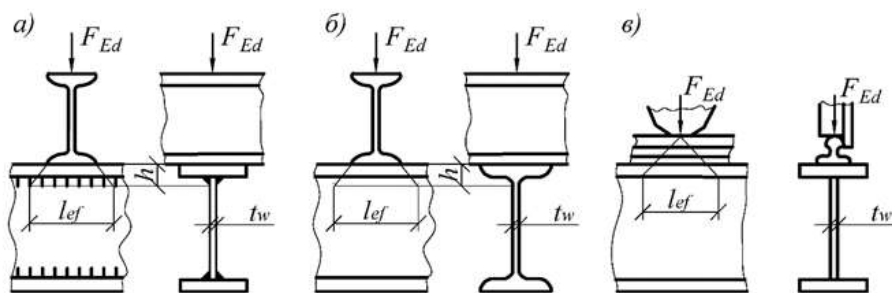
Схемы распределения сосредоточенной нагрузки на стенку балки: а – сварная; б – прокатная; в – сварная или прокатная при нагрузке от колеса крана
